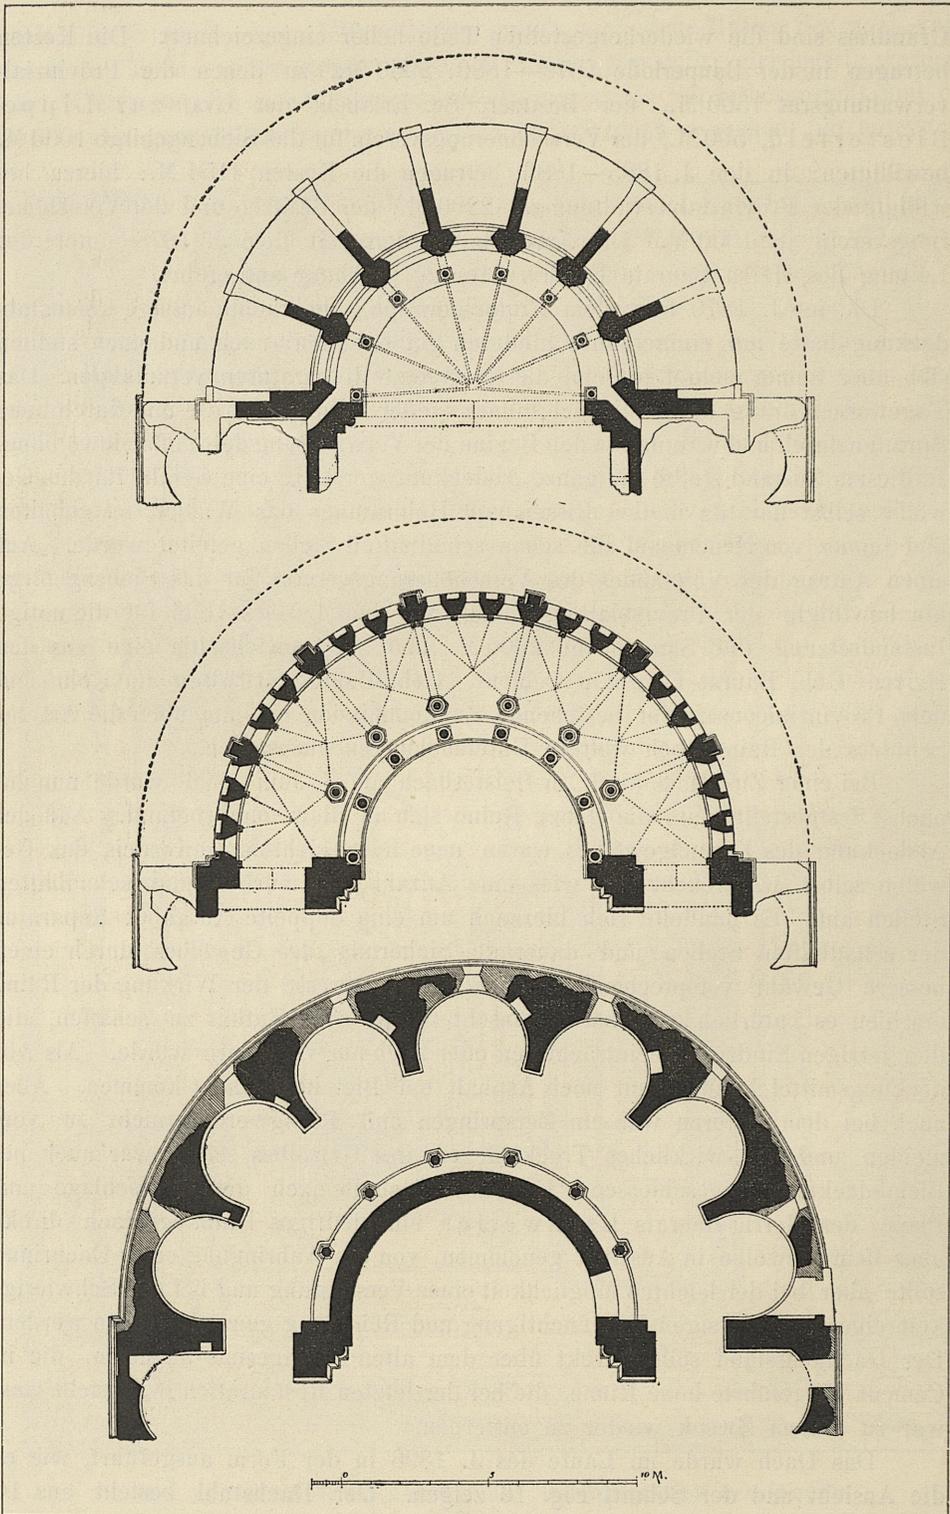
Heisterbach, Abteikirche. Grundrisse von Obergaden, Umgang und Kapellenkranz der Chorruipe.
